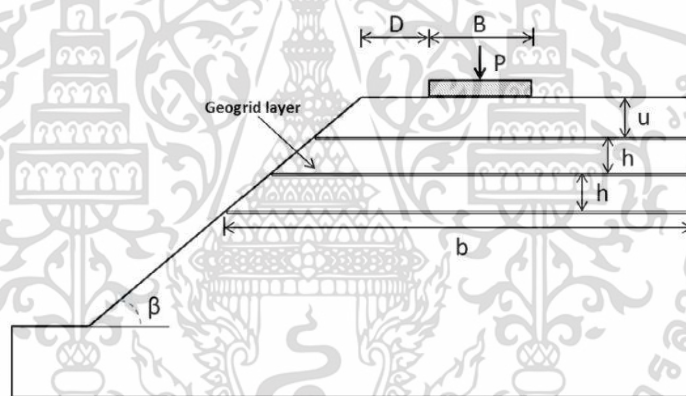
geosynthetic reinforced soil foundation parameters (Chen. 2007)
